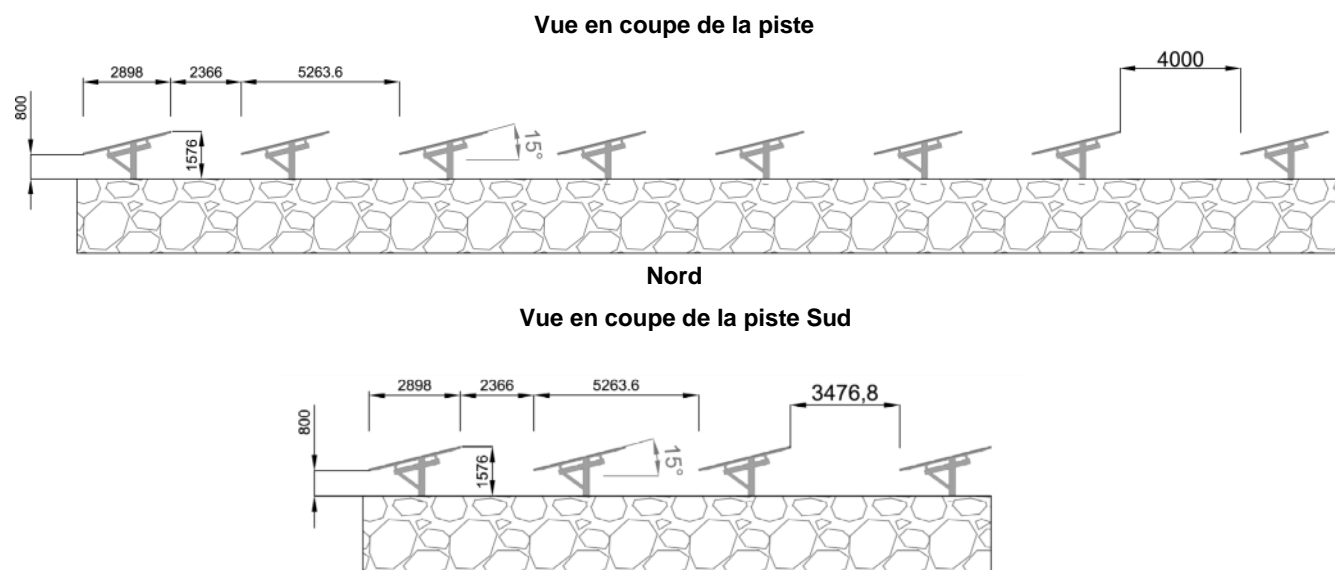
Coupes schématiques des tables d'assemblage sur les pistes bétonnées
